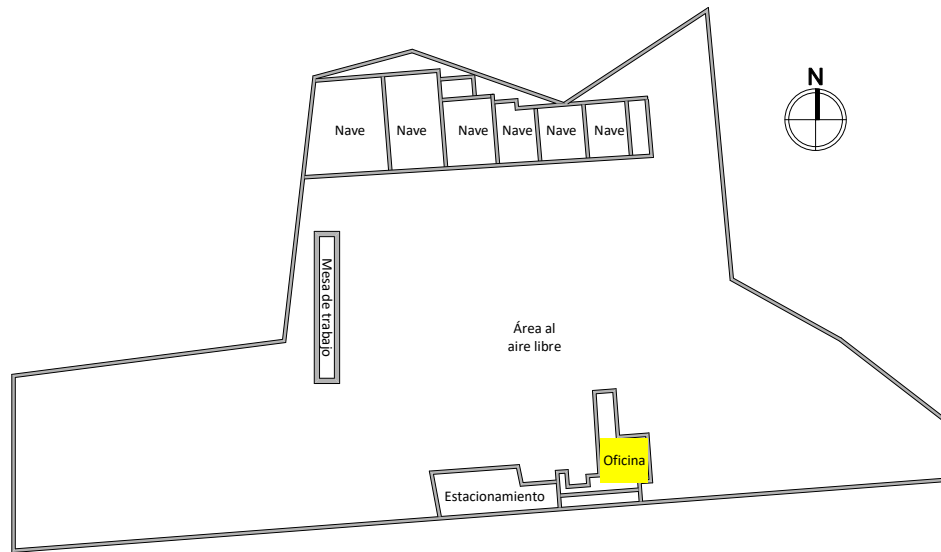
1 Distribución de la planta la empresa en estudio. (Fuente: Elaboración propia).
